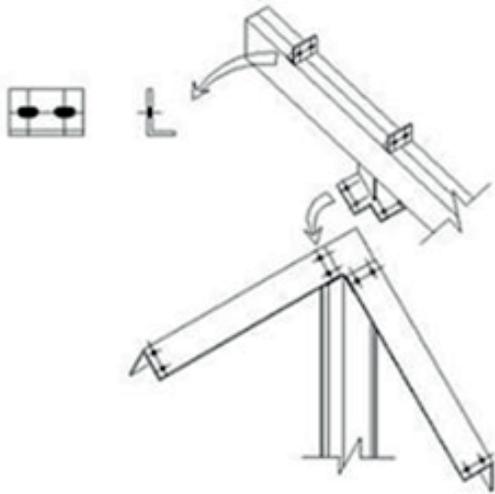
Detalhe de fixação das tesouras nos pilares.
